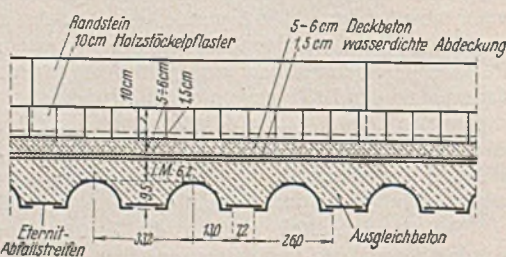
Längsschnitt durch die Fahrbahn mit Belagelisen, Ausgleichbeton, wasserdichte Abdeckung, Deckbeton und Holzstöckelpflaster.
